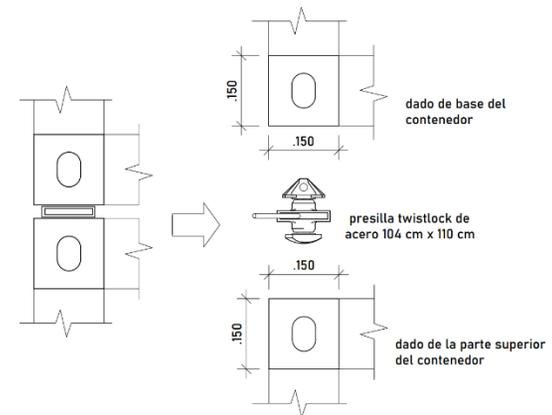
Detalle Placa de Anclaje. Fuente: Propia.
